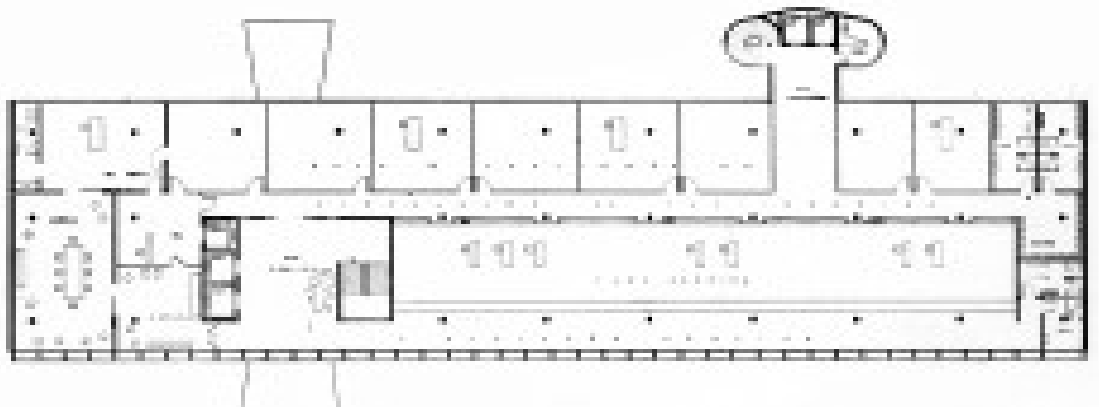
Planta do segundo pavimento com lay-out e divisão dos ambientes. Edifício do Paço.
